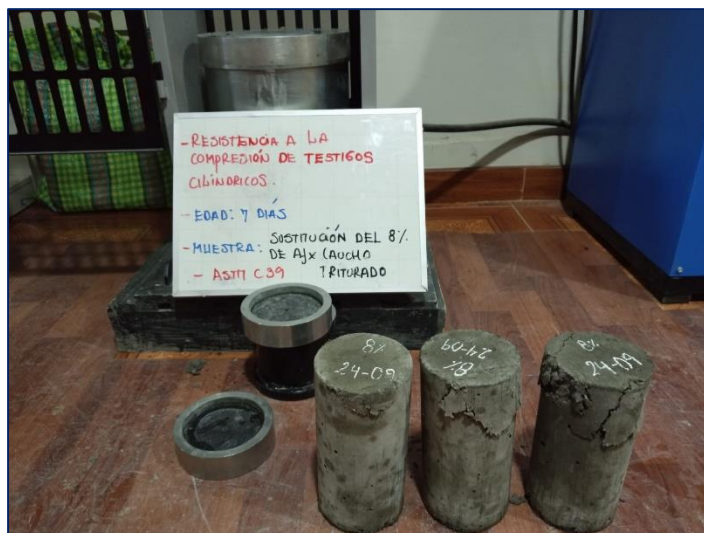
Ensayo a compresión del concreto con caucho triturado.
